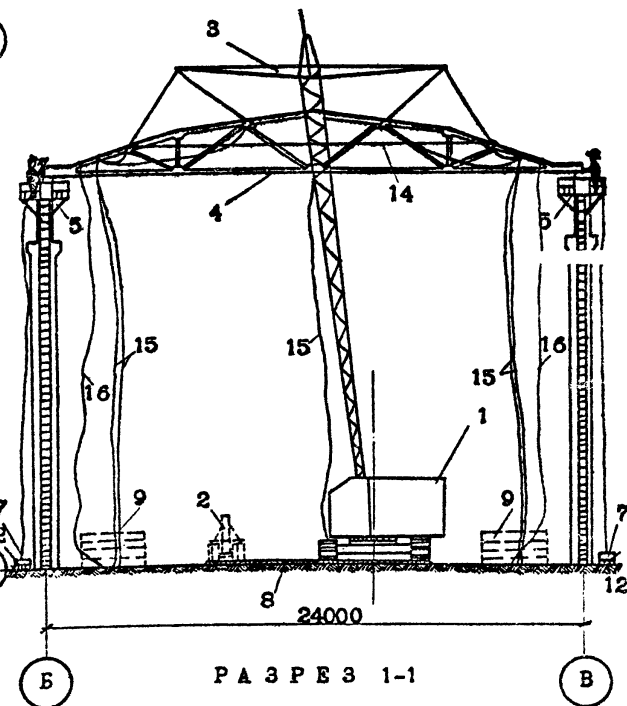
Схема организации рабочего места при монтаже стропильных ферм.
